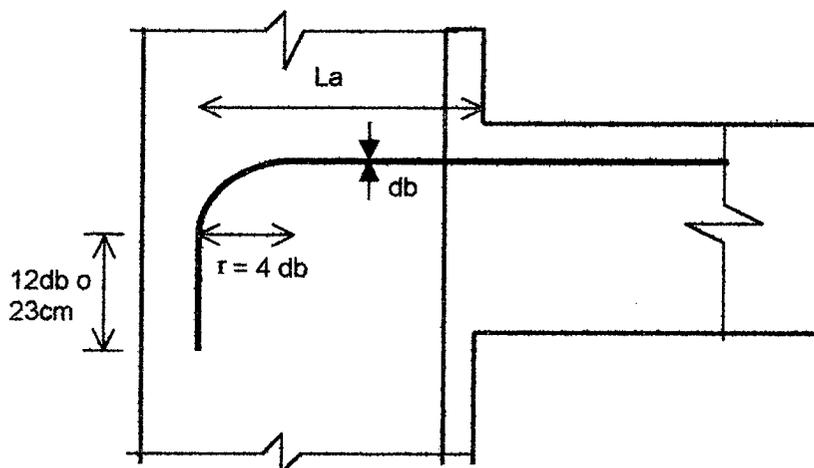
d Anclaje de refuerzo longitudinal de vigas.
